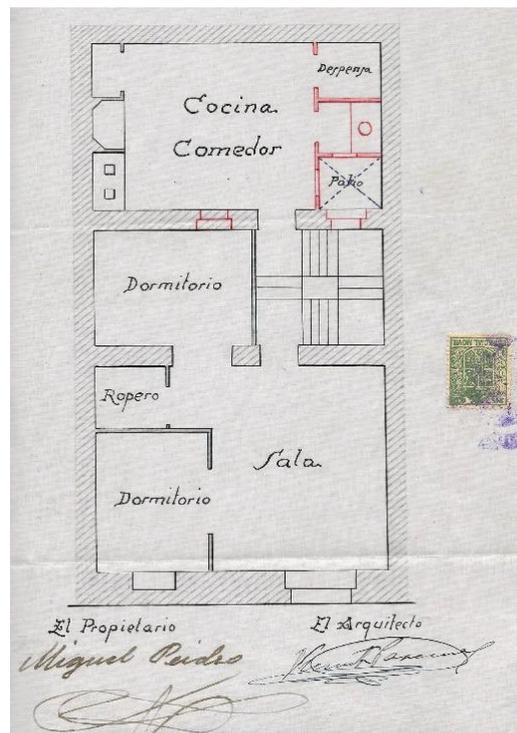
Planta de casa de dos claus de múltiples habitaciones, ancho de fachada 4,75 mts.²⁴
